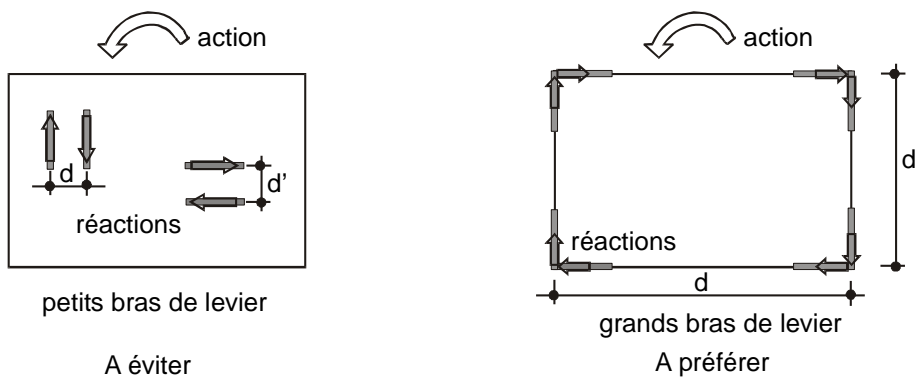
a) Une grande distance entre les éléments parallèles favorise la résistance de la structure à la torsion grâce à un bras de levier important dans le plan horizontal.
